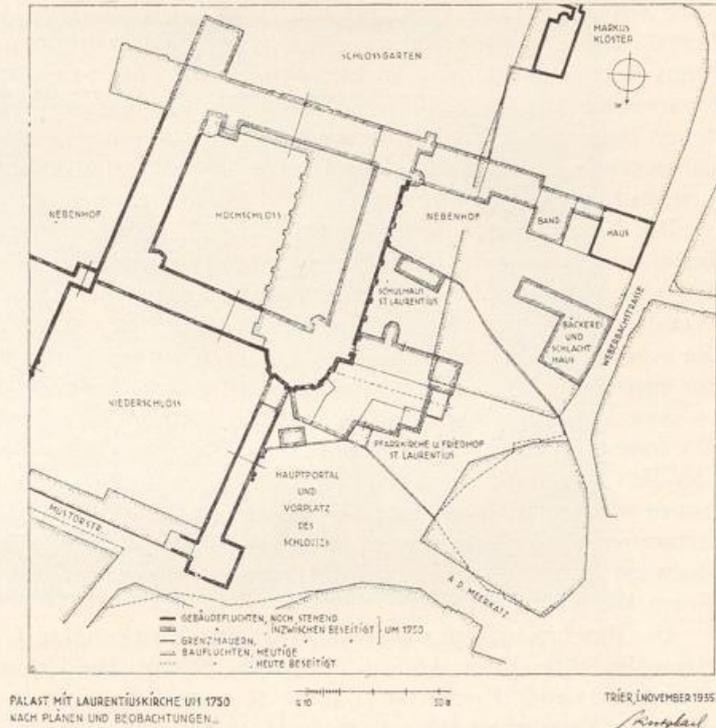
Ehem. Laurentiuskirche und Palast. Lageplan.
